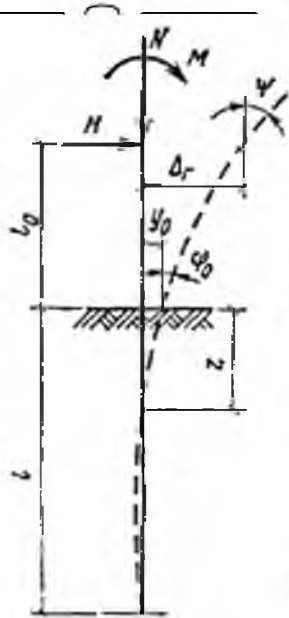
Схема навантажень на 1 п м підірної стіни
